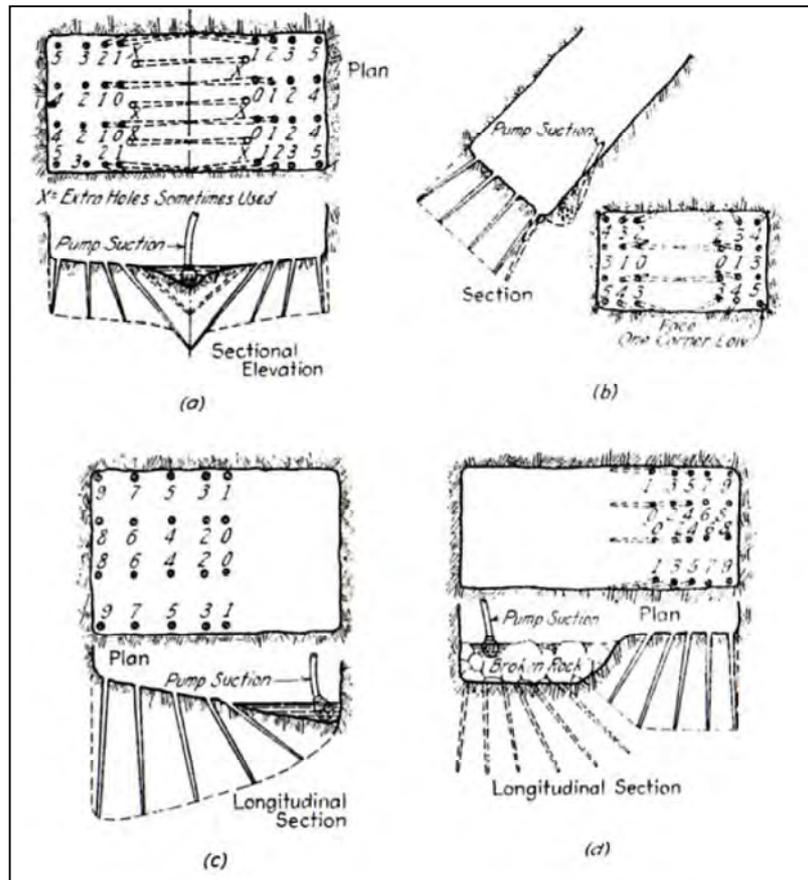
Secciones longitudinales y transversales de algunas plantillas de barrenación. (Fuente LEWIS, R.S. y G.B. CLARK, Elements of Mining, Pág. 185).
